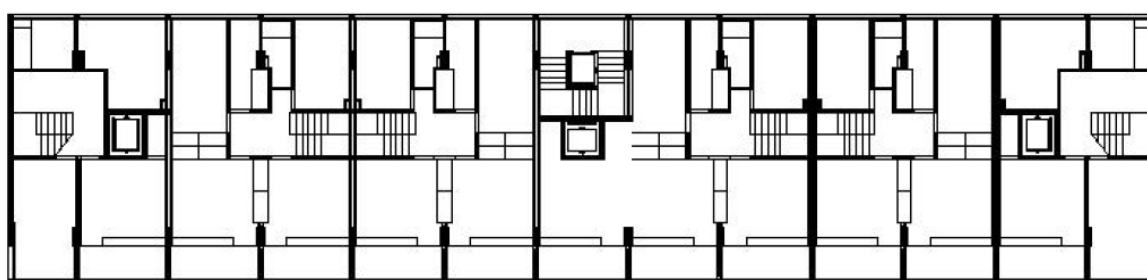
Planta de arquitectura dos pisos 2, 4, 6 e 8.
